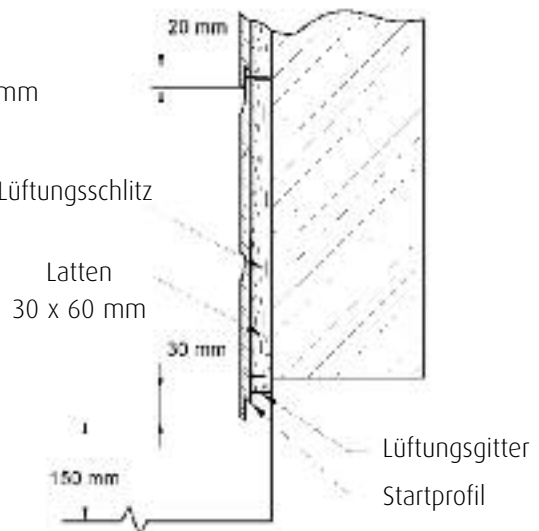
Längsschnitt bei waagerechter Montage mit Wärmedämmung
